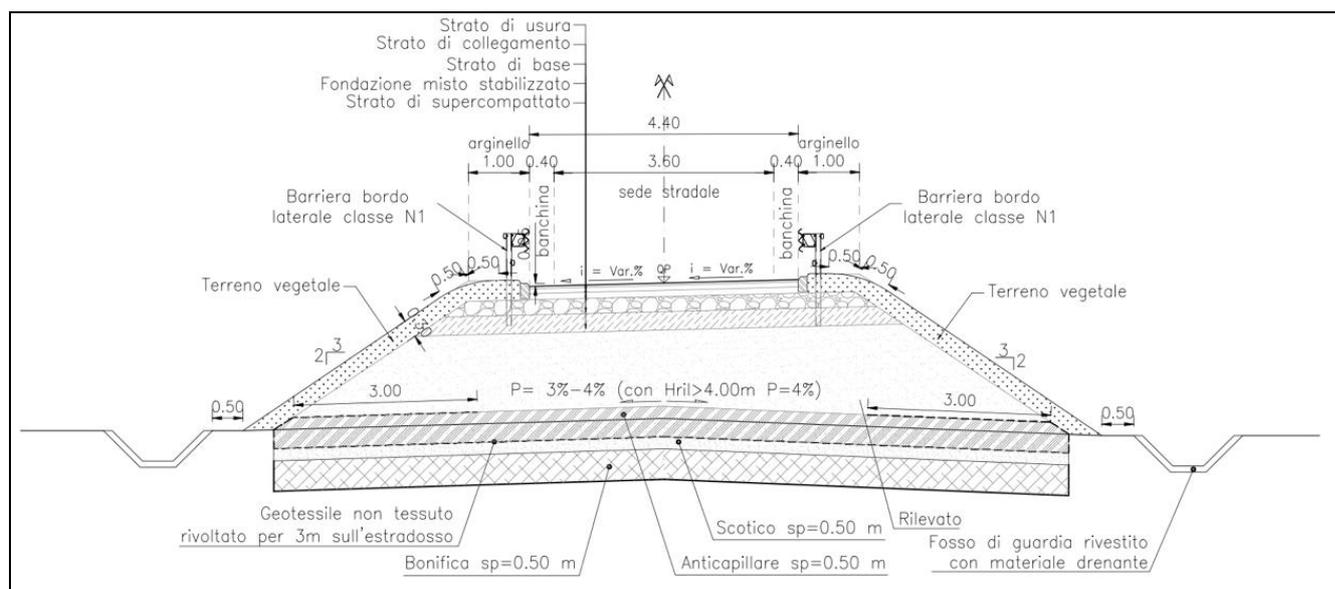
NV_ASSE 1 NORD E SUD: Via Burche Sezione tipo in rilevato
